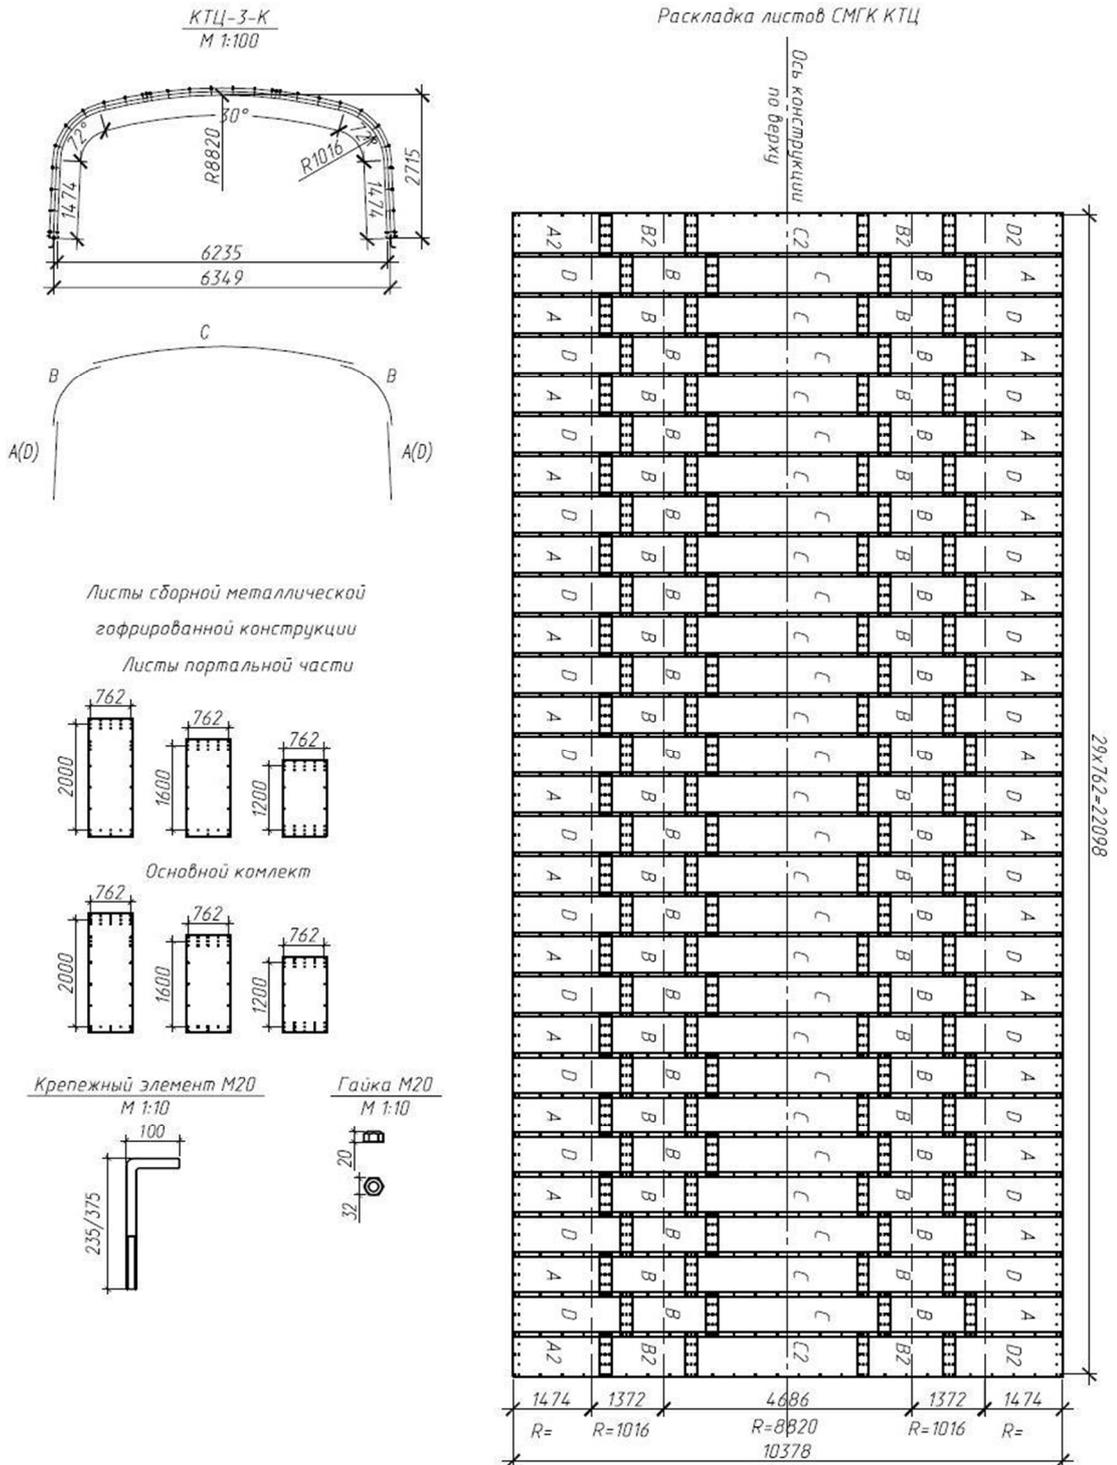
Раскладка листов – сборочный чертеж
